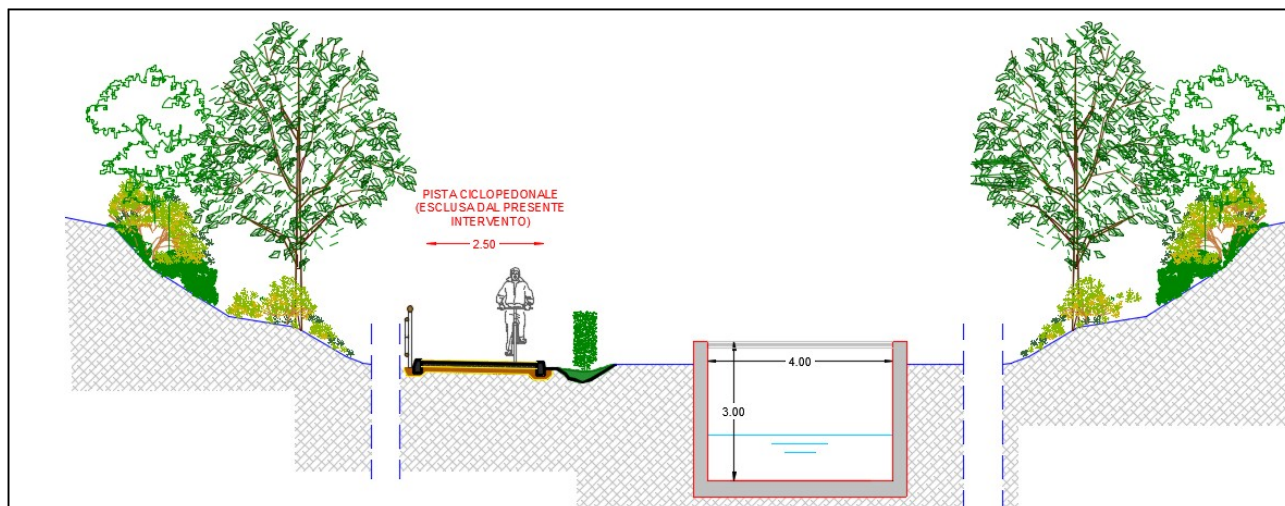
Canale a sezione rettangolare in c.a. aperto con grigliato in acciaio zincato.
